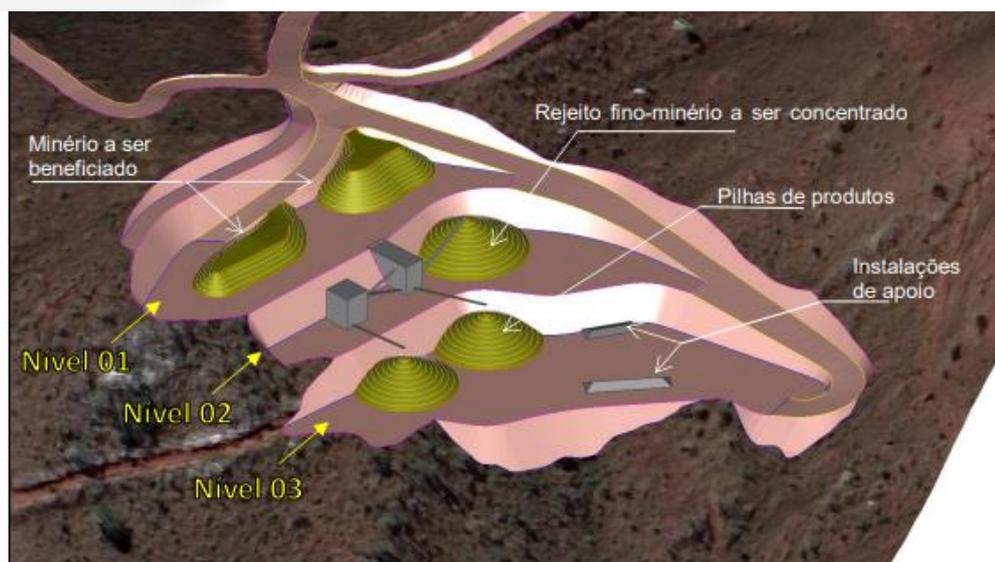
Área de apoio e Unidade de Tratamento de Minério (UTM) a seco
